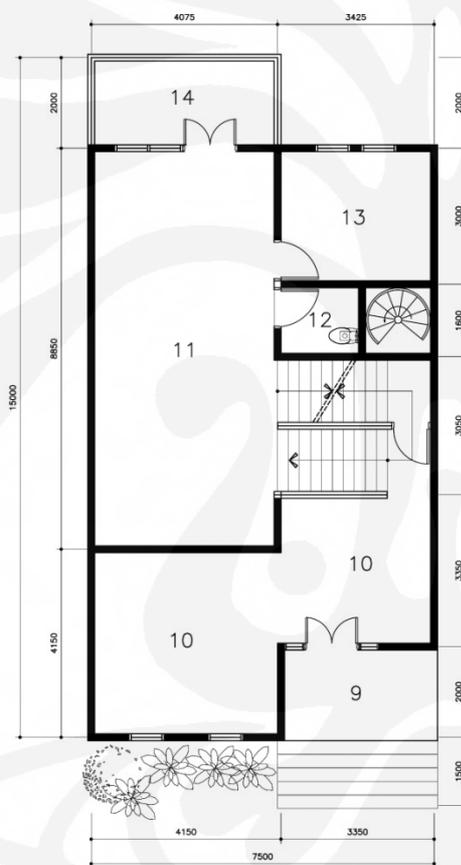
Denah lantai dasar rumah Ibu Lynda
